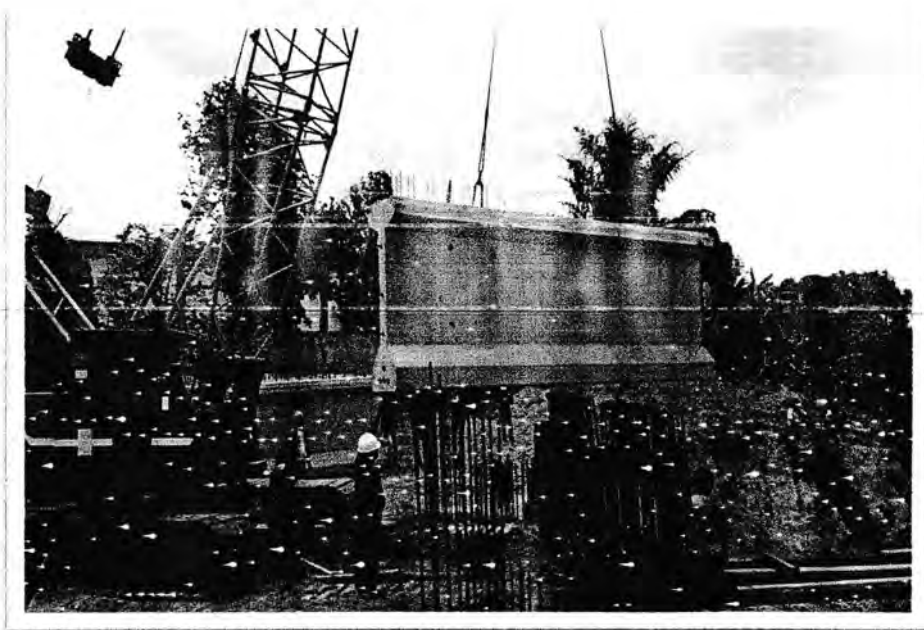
i.2 bentuk jadi rel balok girder
